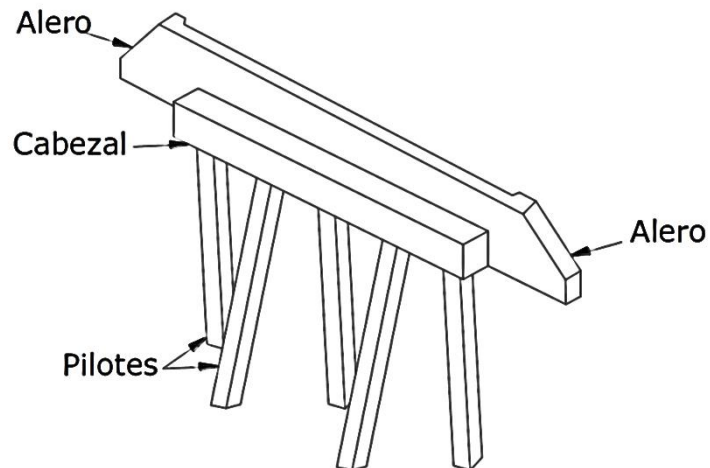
ESTRIBO DE CABALLETES SOBRE PILOTES CON ALEROS CORTOS
